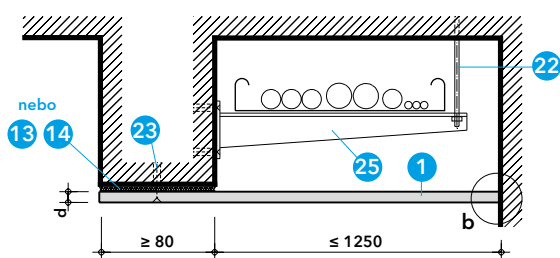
průstup instalačního kanálu lehkou příčkou
